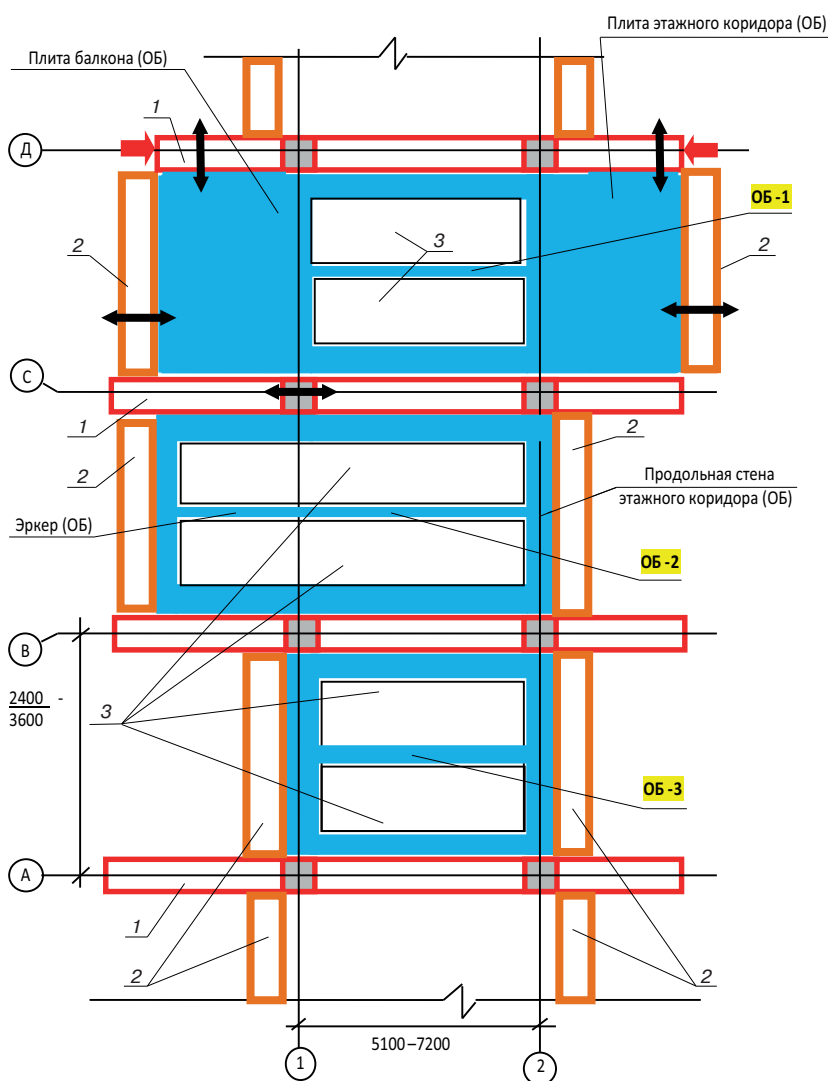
Заливка плиты перекрытия квартиры на фрагменте стапеля. Модуль однокомнатной квартиры состоит из трех объемных блоков (ОБ-1, ОБ-2, ОБ-3): 1 – поперечная рама стапеля; 2 – продольные борта плит этажного диска перекрытия; 3 – сборные преднапряженные плиты перекрытия
